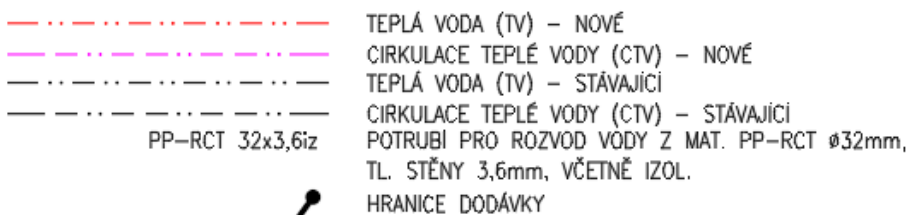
DETAIL ZAPOJENÍ MĚŘÍCÍ SESTAVY:
